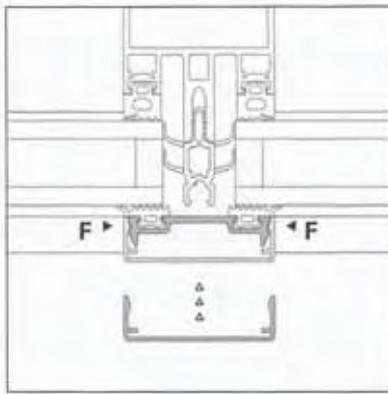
Einschnappen der Deckleiste einer Pfosten- Riegel- Fassade mit Federkraft F
